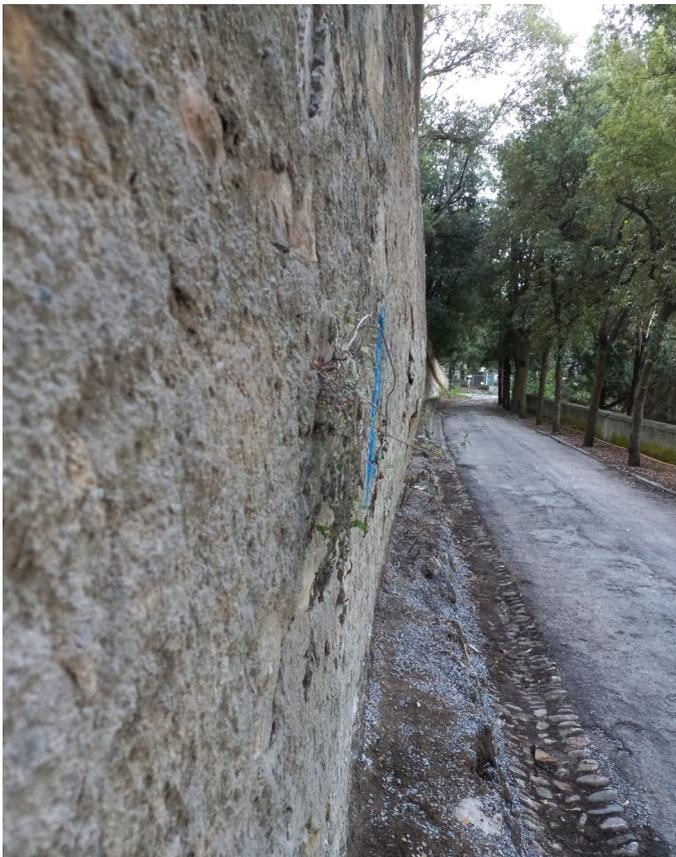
stato attuale (spanciamento e lesioni, vista laterale)
